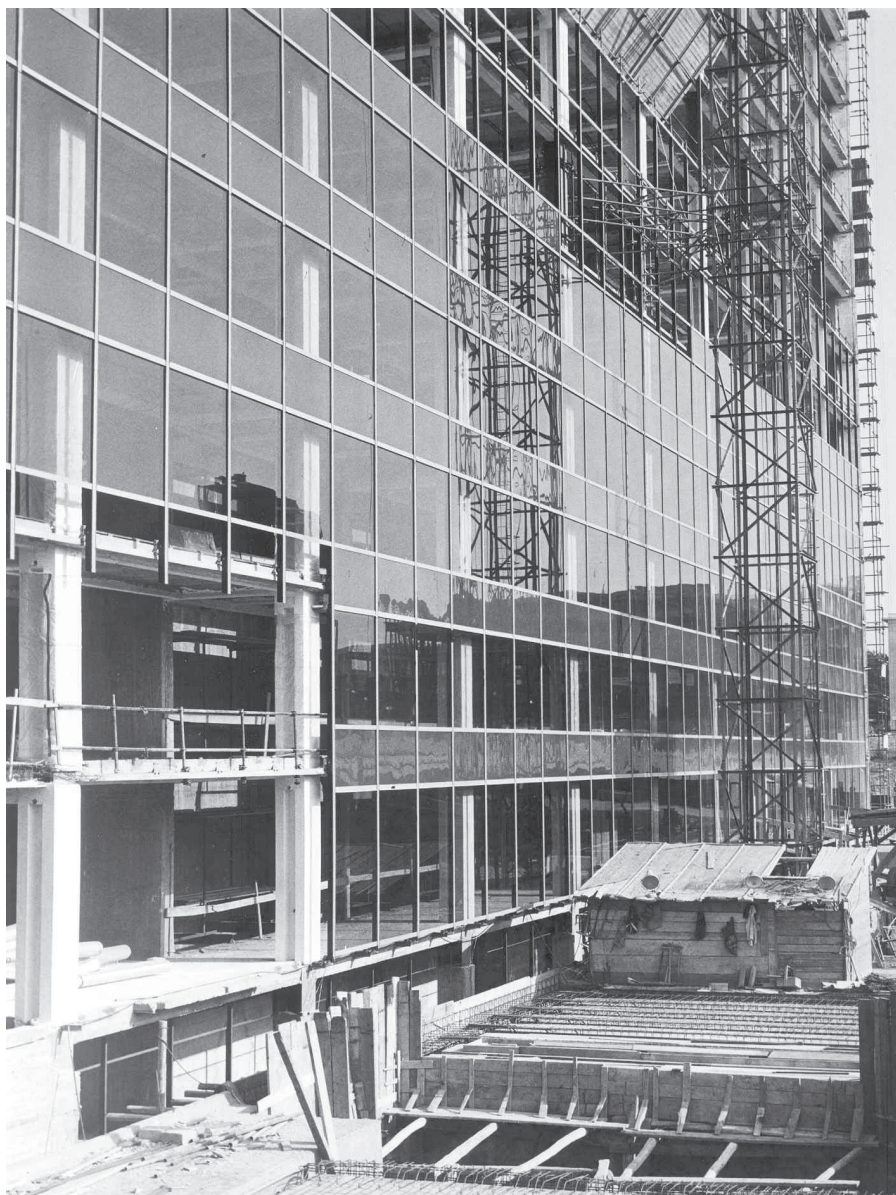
Il cantiere durante il montaggio della facciata, agosto 1961 (ASE)
